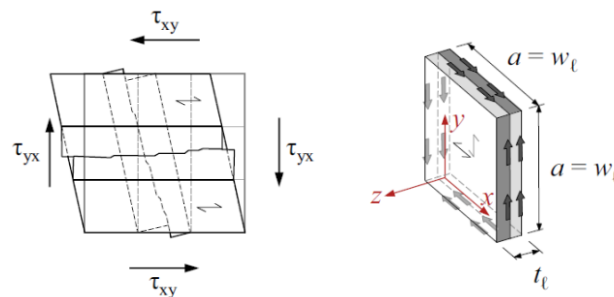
Représentation schématique du mécanisme de cisaillement d'un panneau CLT en section brute
